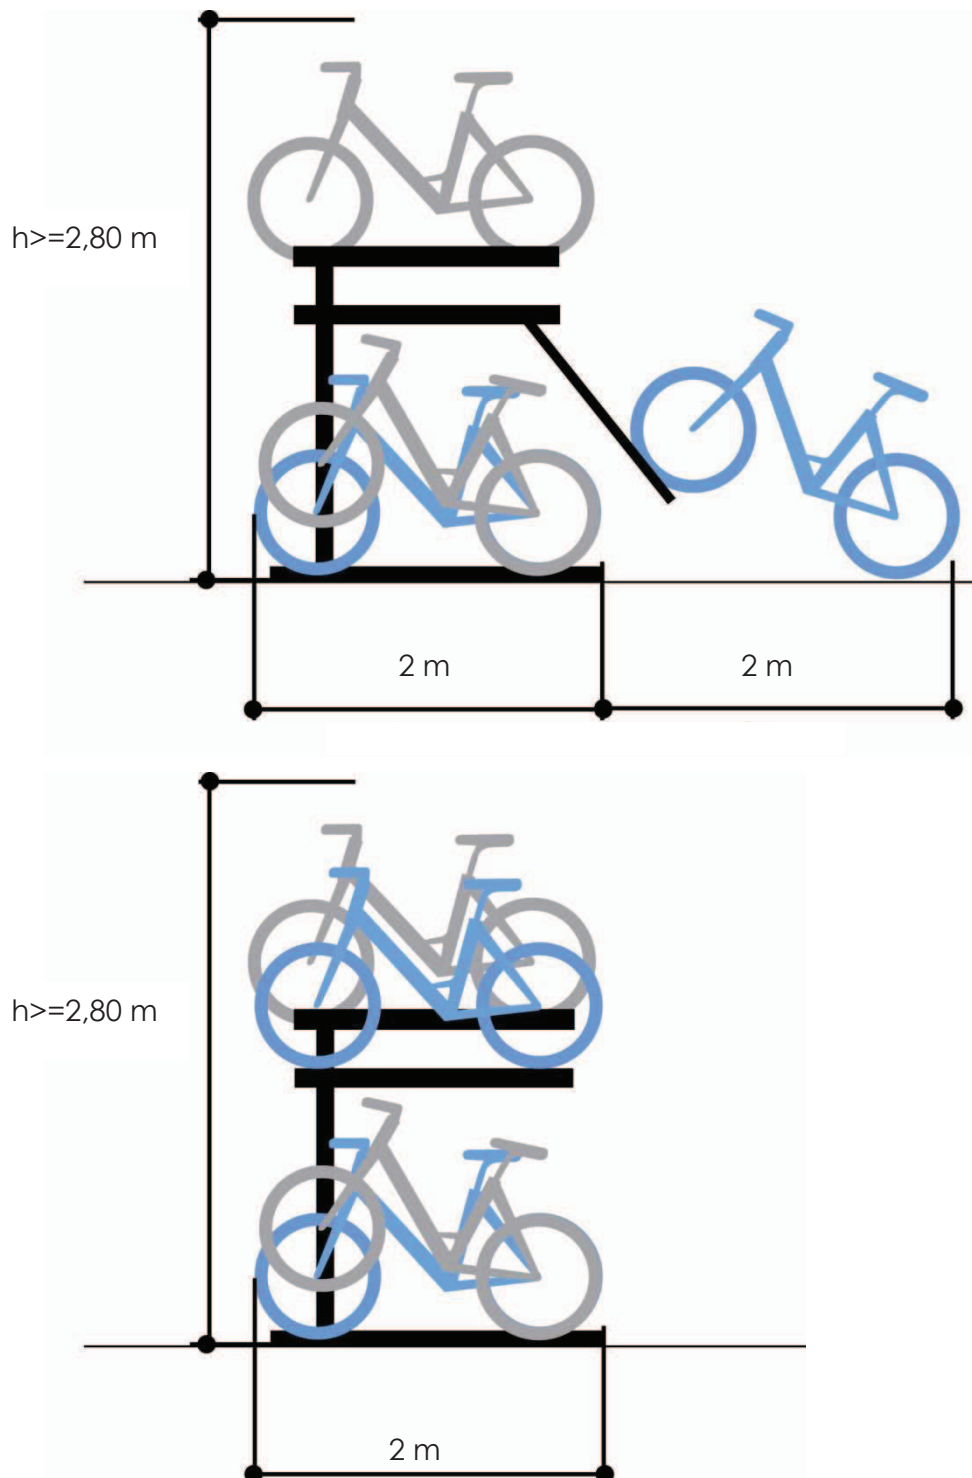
Rangement sur deux niveaux allié à une disposition resserrée
